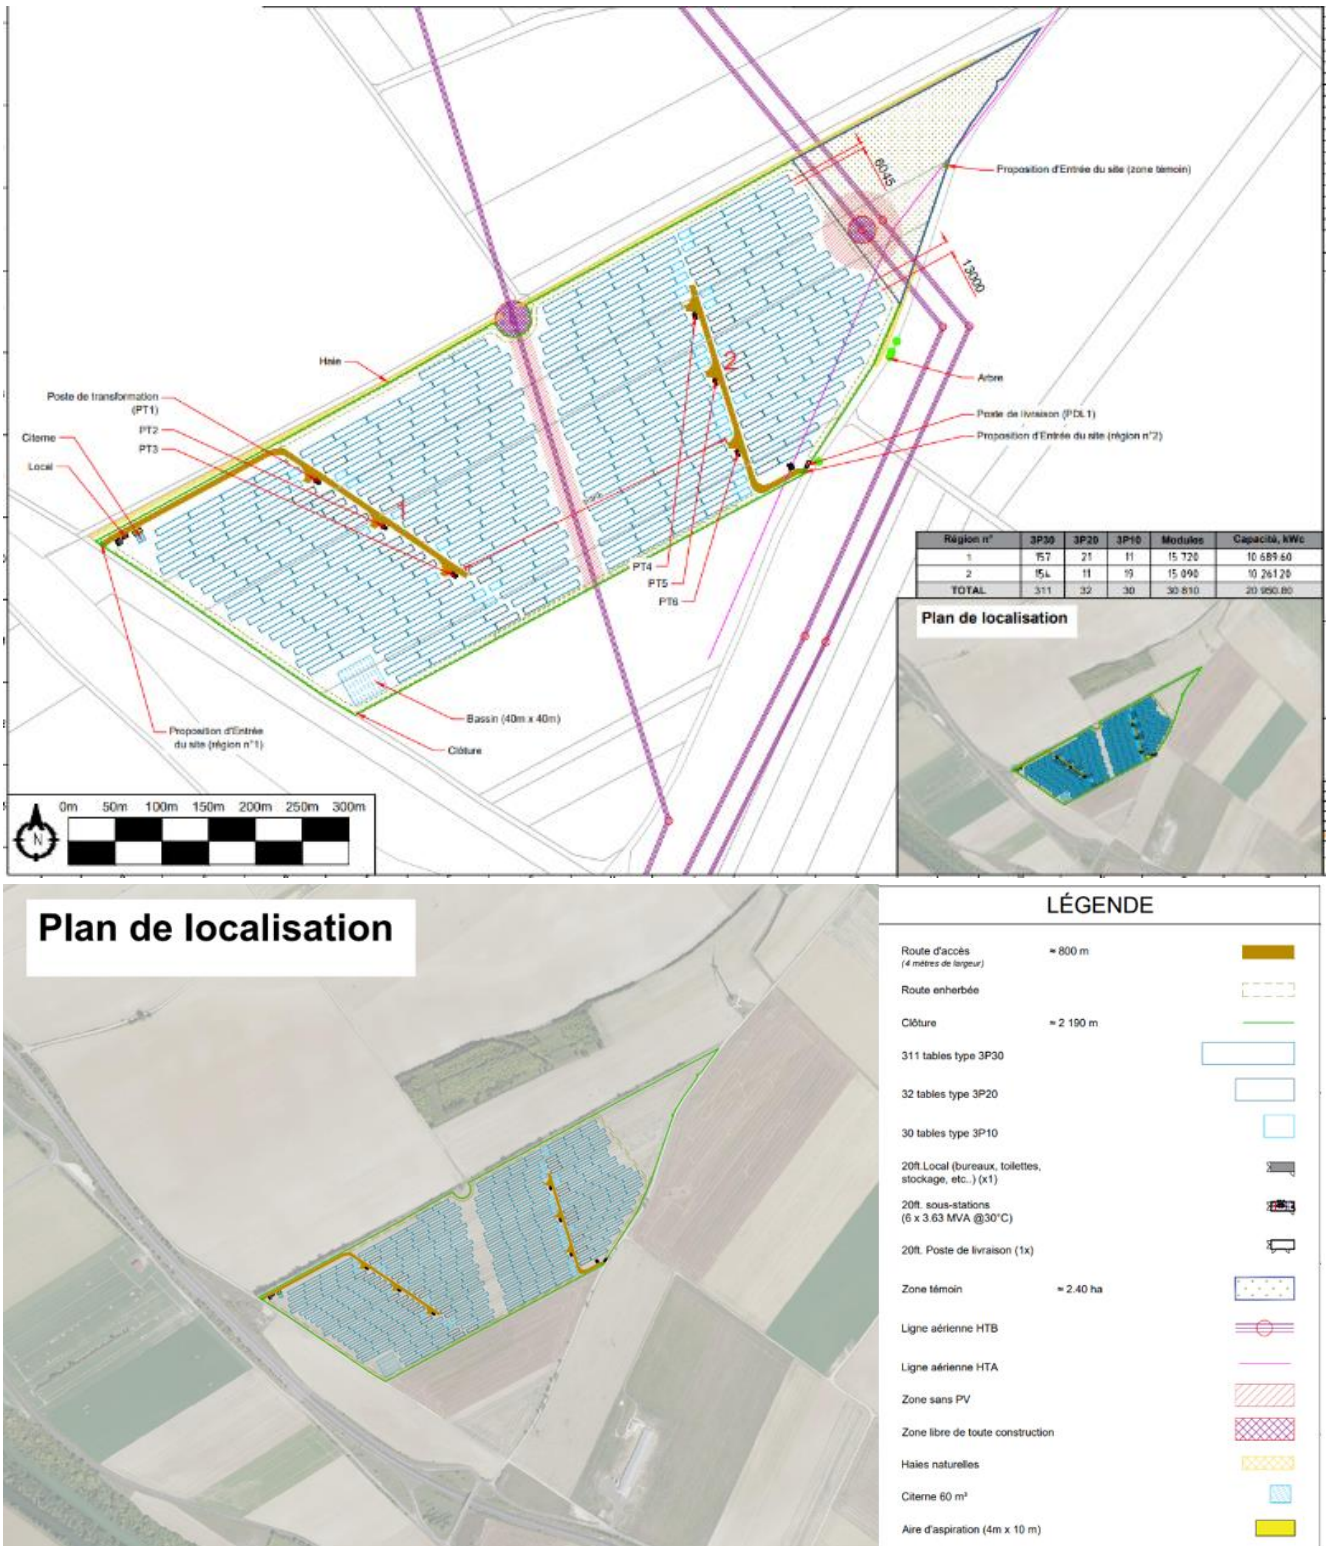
Plan d'implantation des panneaux photovoltaïques du projet de La Chaussée-sur-Marne (Source : STATKRAFT RENOUEVELABLES)
